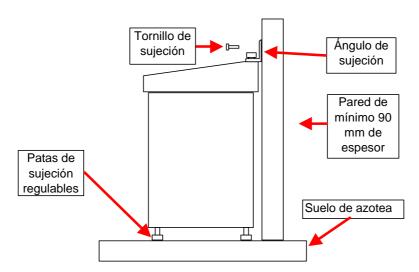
Esquema de montaje de armario de exterior en azotea
